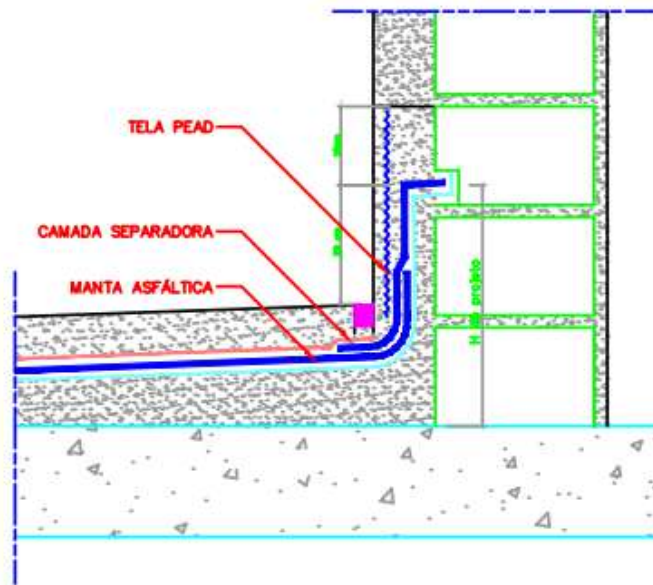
Detalhe virada da manta e ancoragem na alvenaria.
